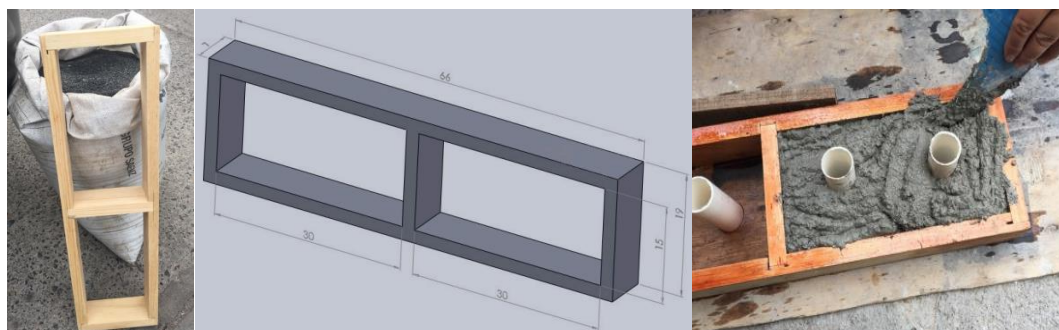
La imagen a) muestra el HDPE triturado y molde de madera, la imagen b) muestra las dimensiones del molde, se observa en la imagen c) el proceso de llenado del molde.
